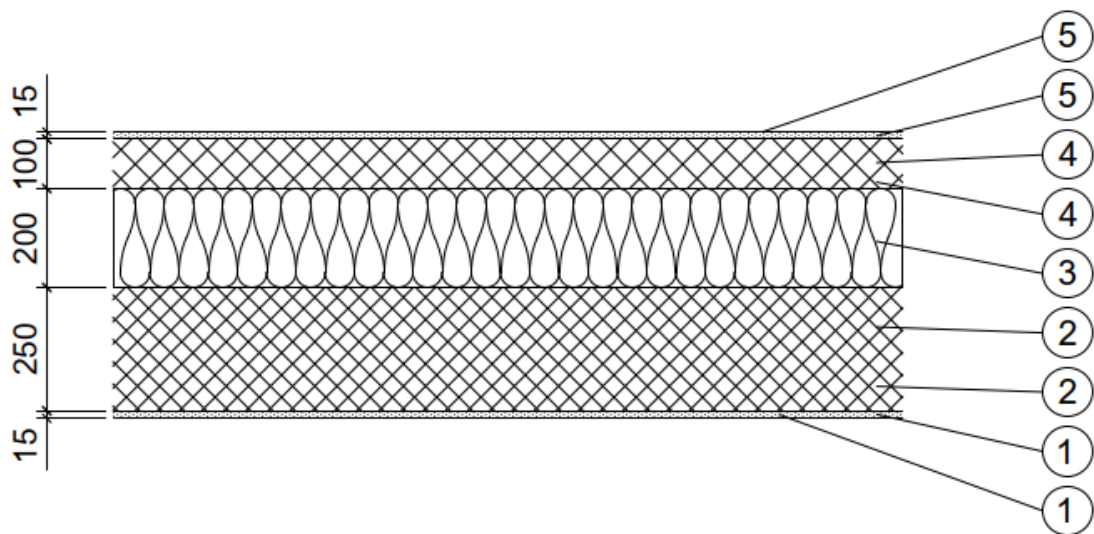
Zweischalige Stahlbetonwand mit Kerndämmung
